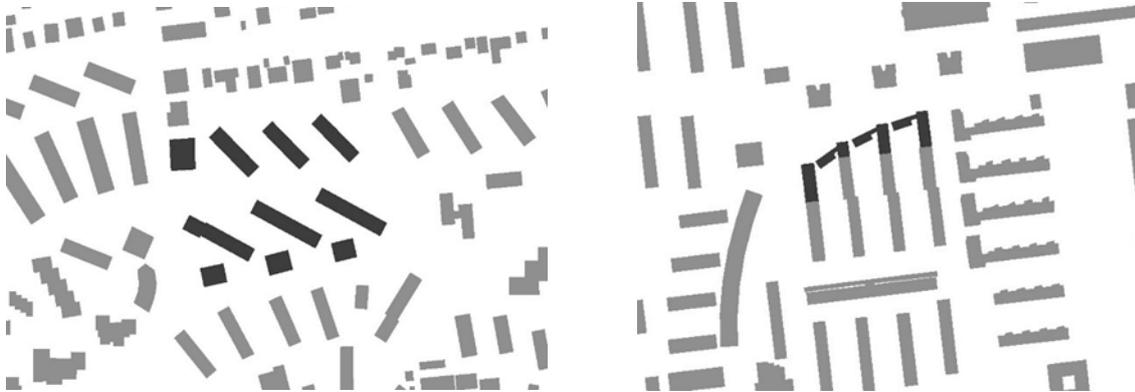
hellgrau Bestand, dunkelgrau ergänzte bzw. sanierte Gebäude. links: Hamburg, Altenhagener Weg, rechts: München Aschbrennerstraße; Quelle: eigene Darstellung
